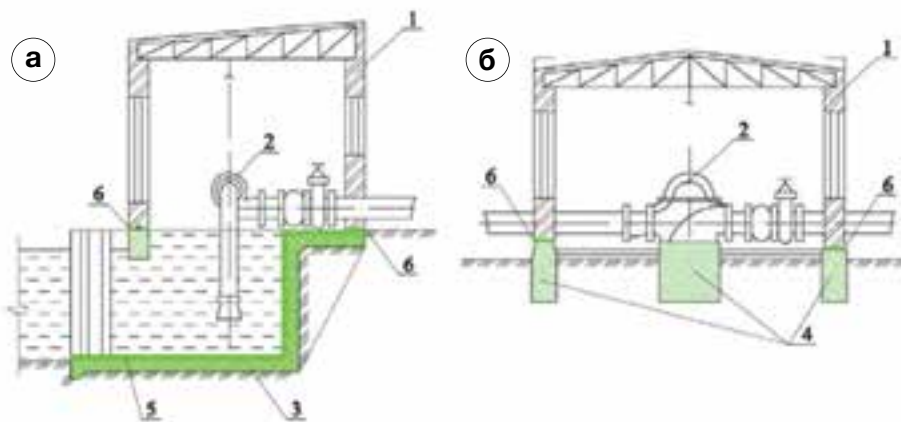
Здание насосной станции: а) совмещено с водозаборным сооружением; б) отдельно стоящее. 1 — здание станции; 2 — насосный агрегат; 3 — водозаборное сооружение из бетона с добавкой MasterGlenium®; 4 — фундаменты здания из бетона с добавкой MasterGlenium®; 5 — проникающий состав MasterSeal® 501 или гидроизоляционные составы MasterSeal® 531, MasterSeal® 588; 6 — гидроизоляция из состава MasterSeal® 531
